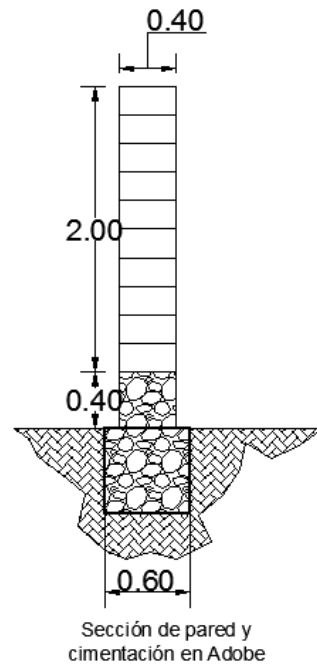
Sección transversal de pared y cimentación de vivienda de Adobe
